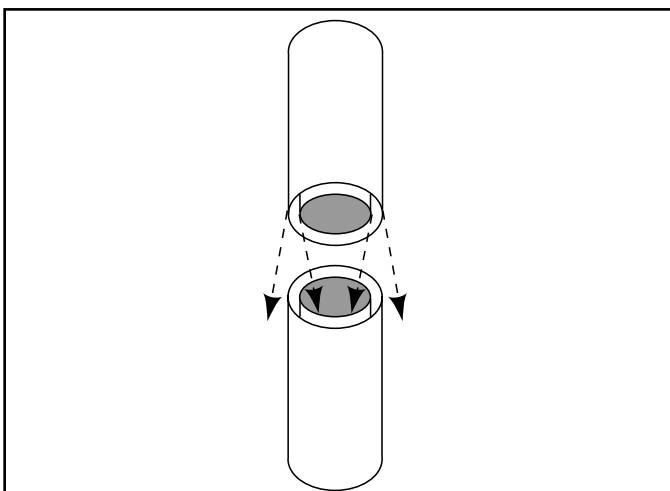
Ensamblado de las secciones del cañón de la chimenea
